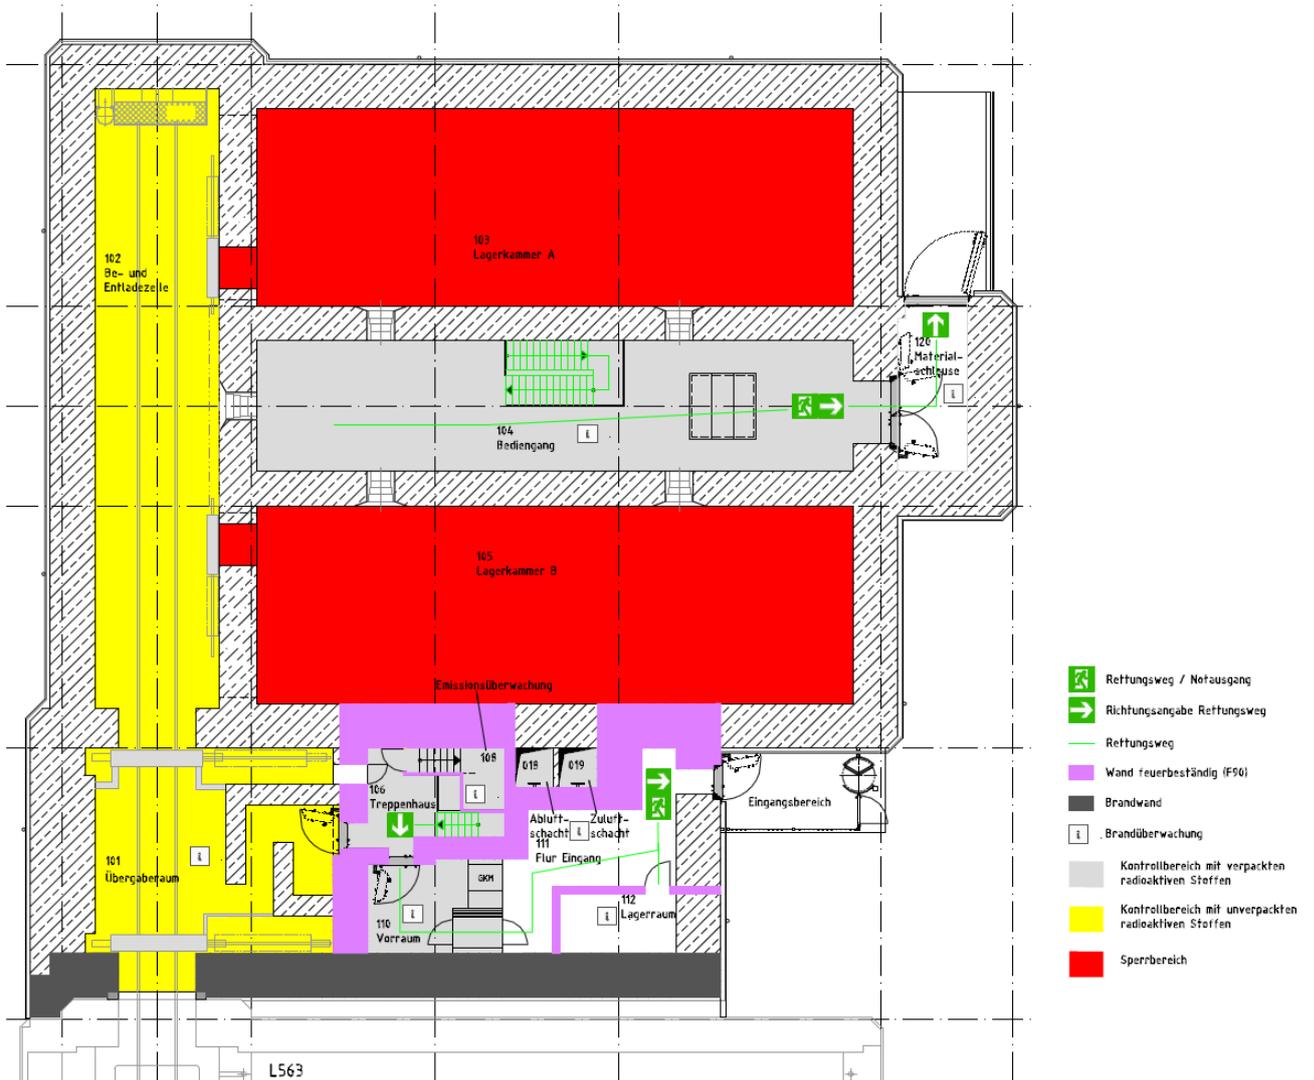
Gebäudeplan, Erdgeschoss
